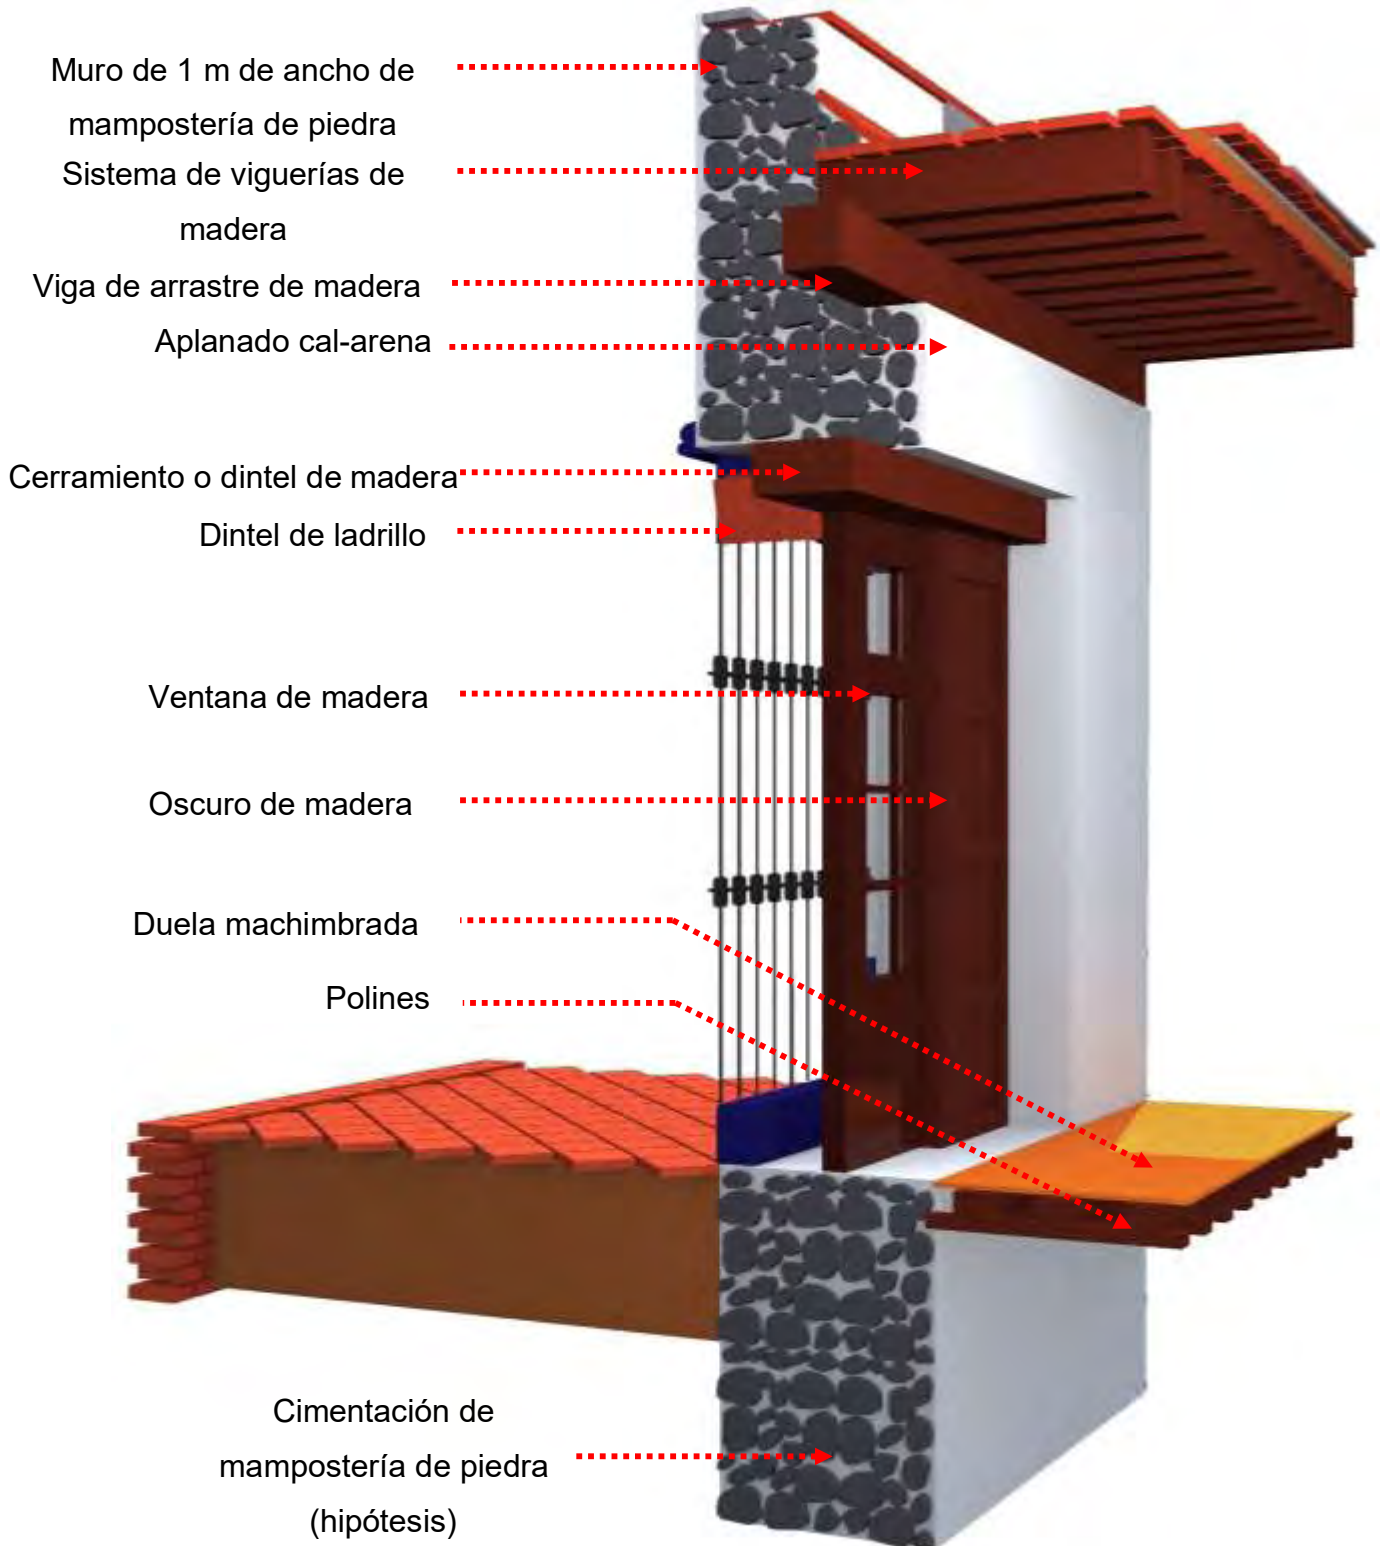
Detalle interior del sistema constructivo de la Casa del Hacendado.
